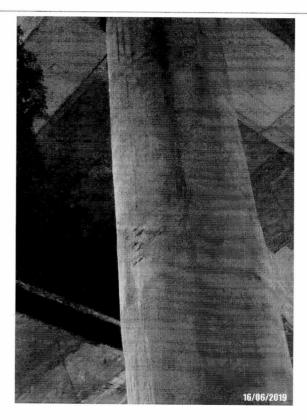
Detalhe de pilares com pequenas fissuras e pontos de desplacamento de concreto.
